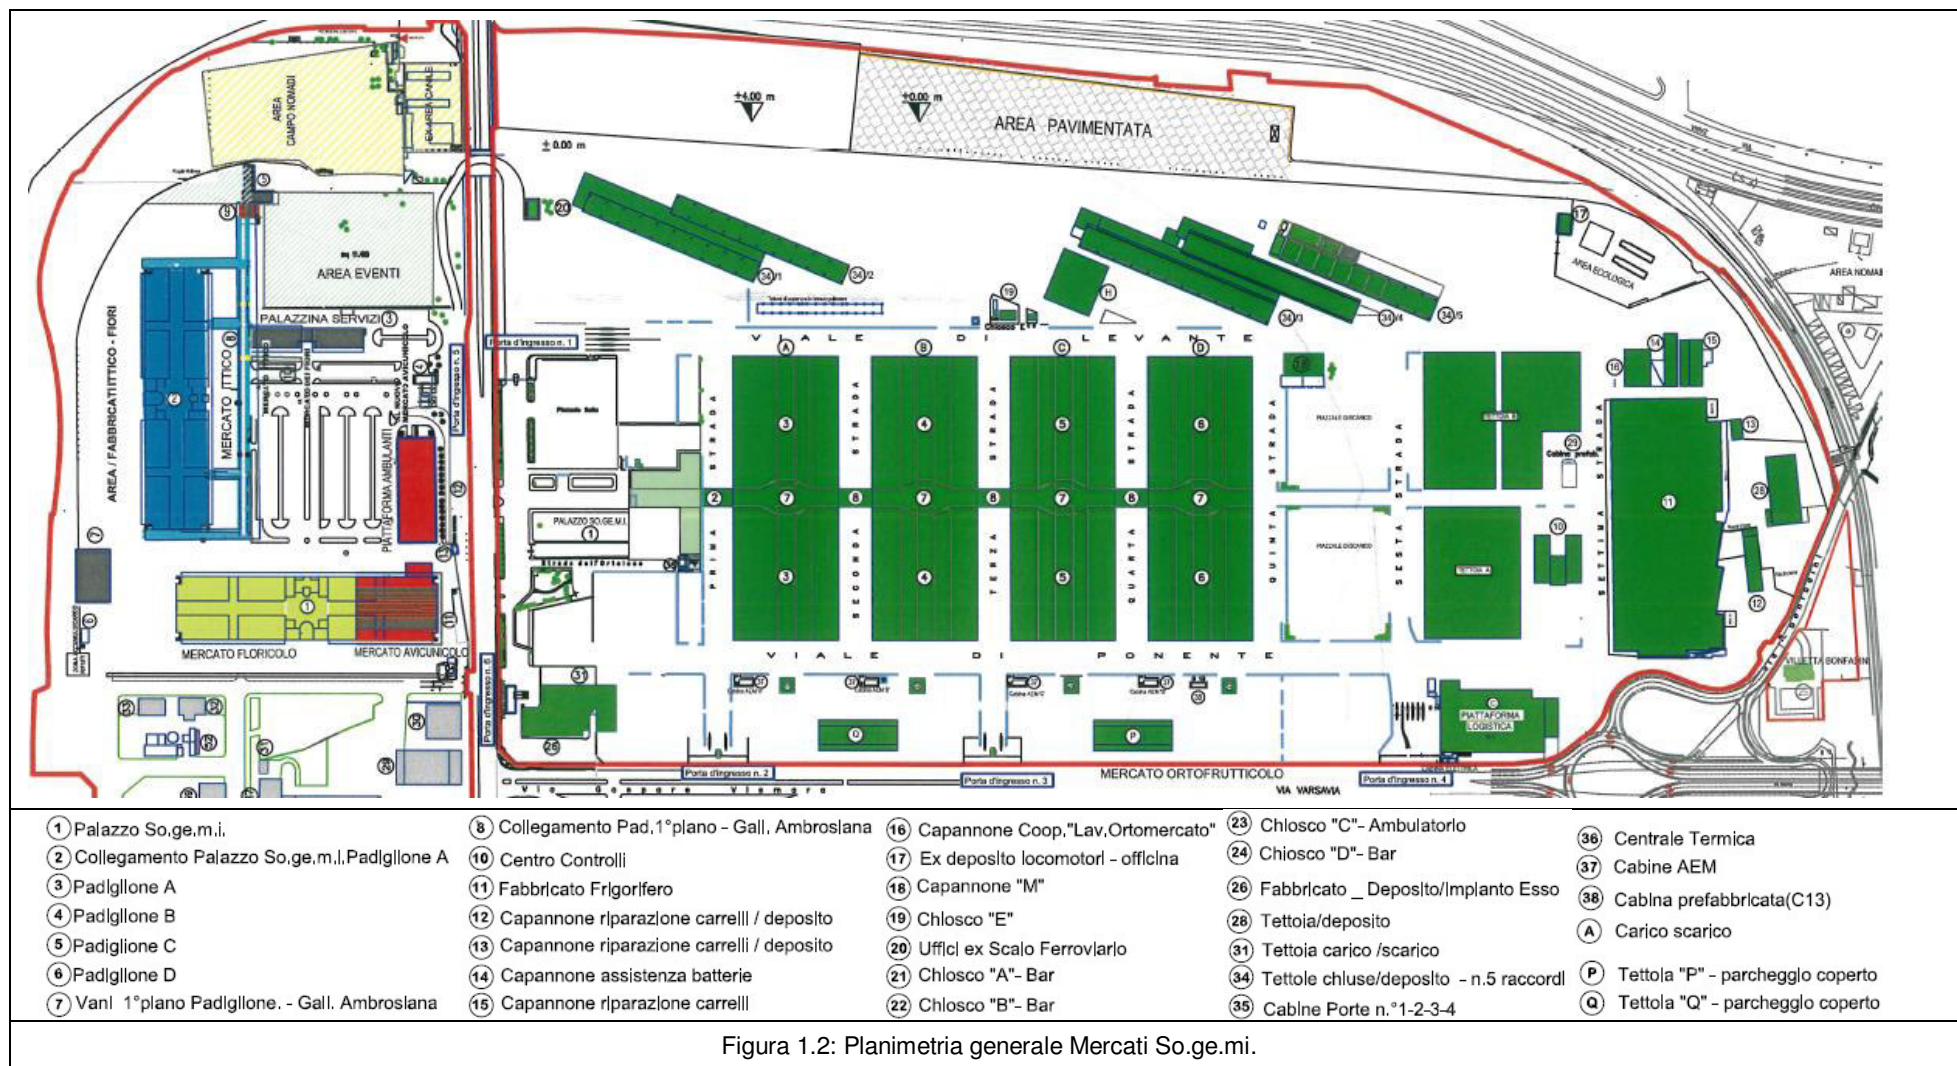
Planimetria generale Mercati So.ge.mi.
